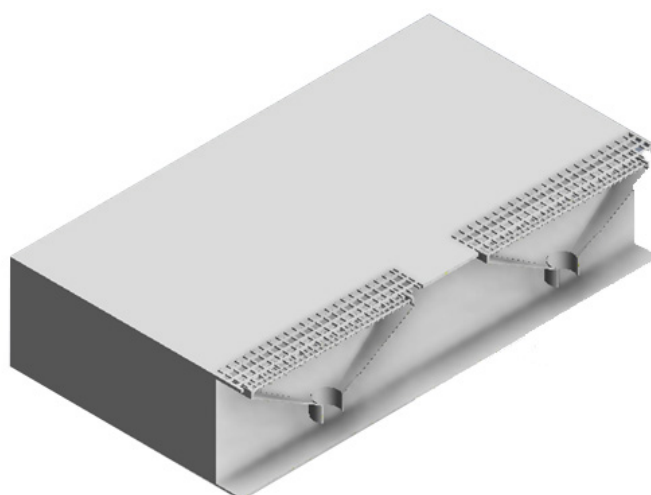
Sezione assonometrica laterale bocchette, cavedio e terrapieno.
